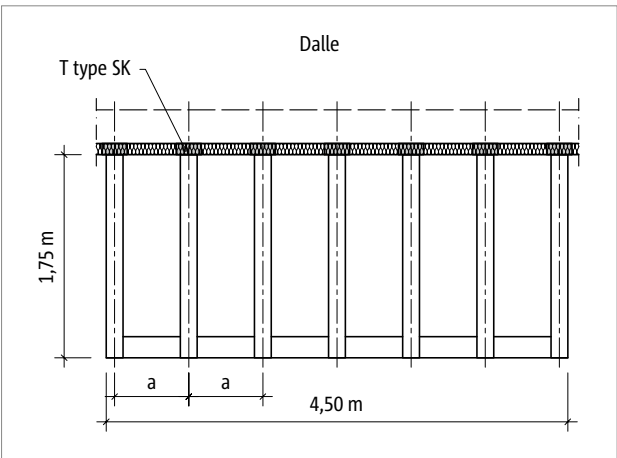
Schöck Isokorb® T type SK : vue en plan
